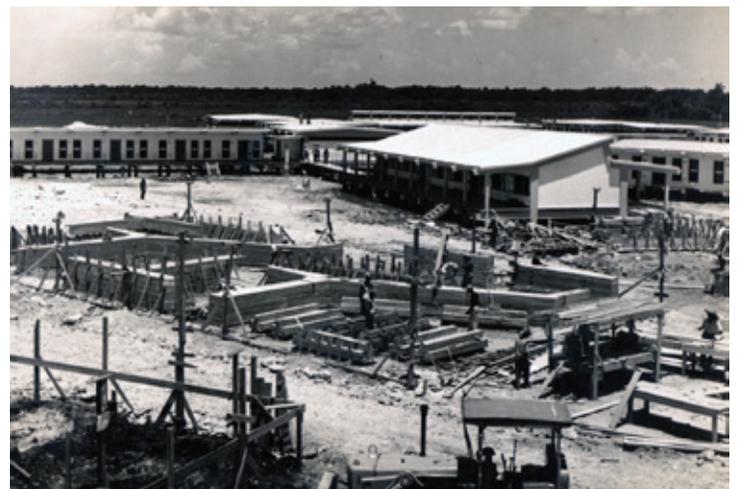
Estructura portante de comedores por columna-viga inclinada-monitor, prefabricada *in situ*, 1962. Fuente: Fondos del antiguo Ministerio de Obras Públicas. Archivo y Biblioteca Fernando Salinas, Empresa RESTAURA, OHC.
